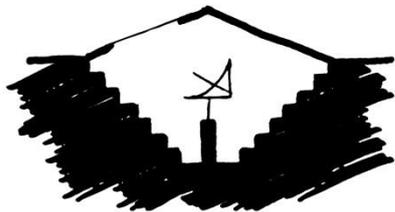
Sección esquemática del espacio escalonado con soporte fijo para el instrumento.
